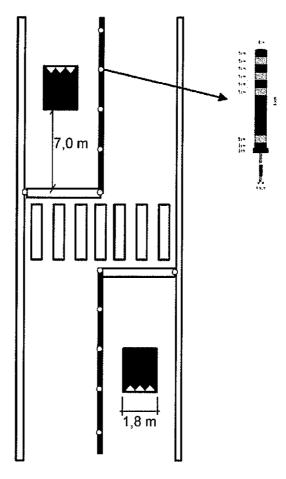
Passadeiras de peões com aplicação de redutores de velocidade (esquema tipo)
